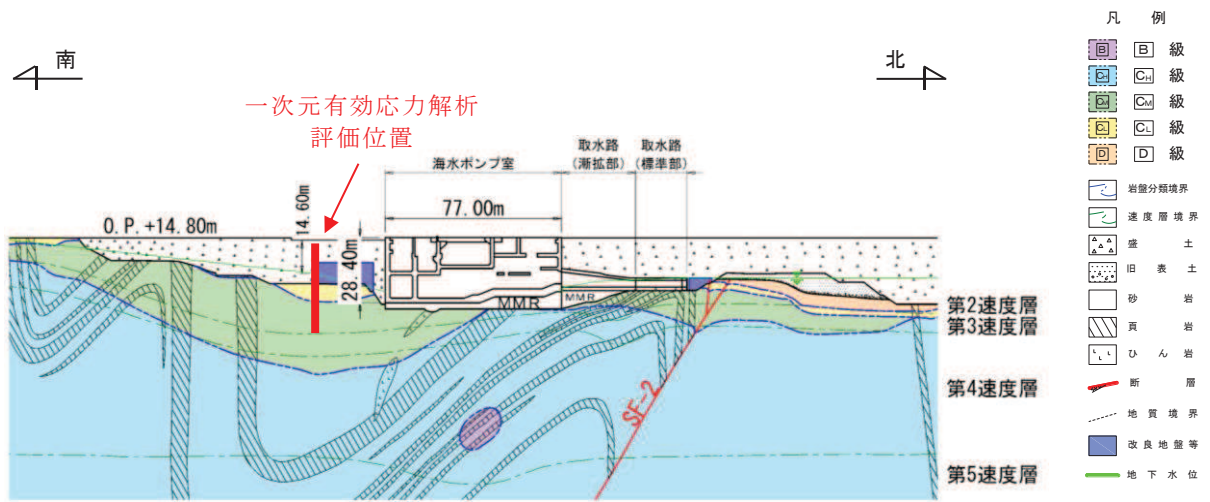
海水ポンプ室評価対象地質断面図 (断面①)
